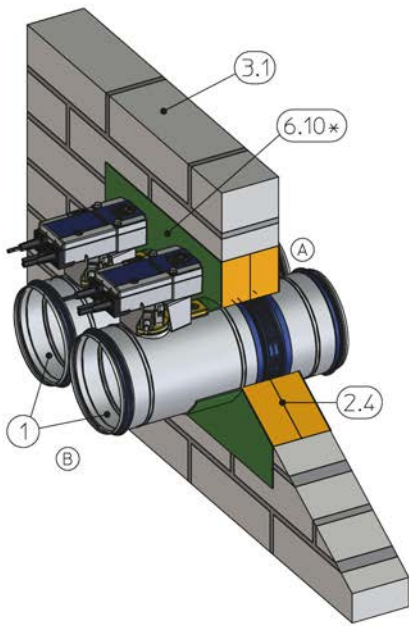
Монтаж в сплошной стене с огнестойкой плитой без применения строительного раствора
